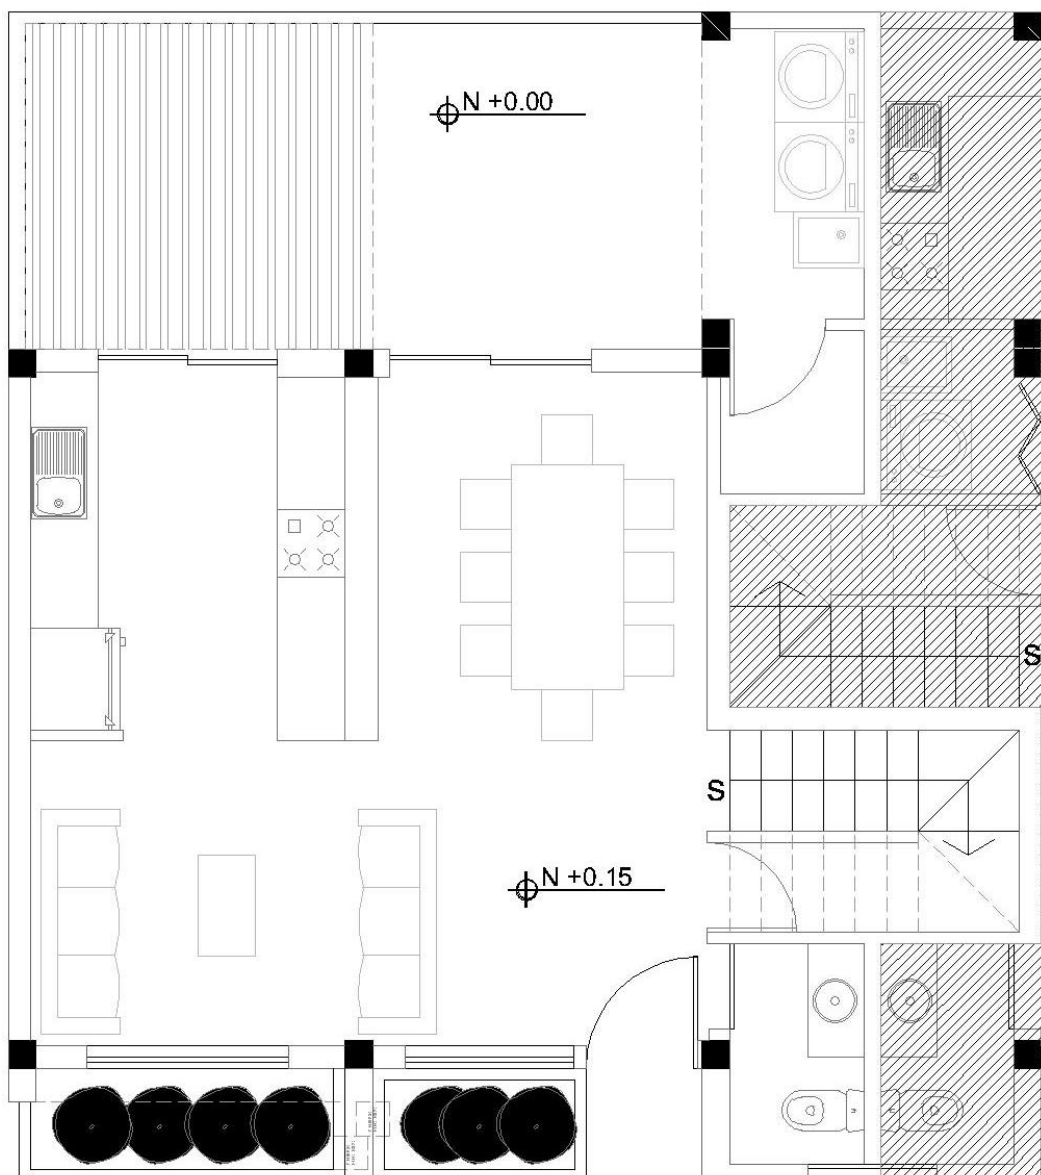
CASA TIPO A – PLANTA BAJA
